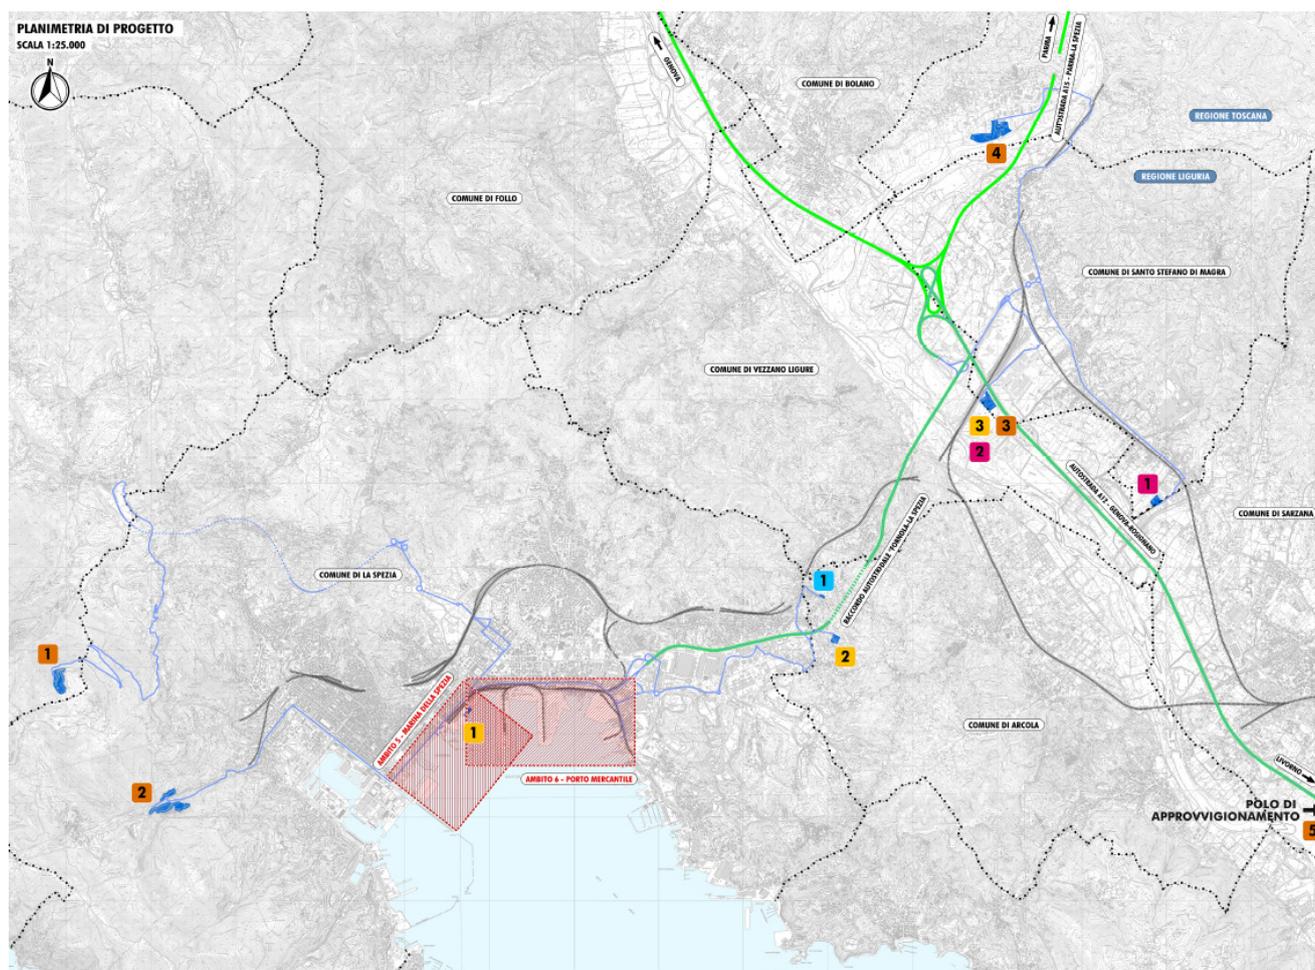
planimetria generale con individuazione dei percorsi di approvvigionamento/conferimento dei materiali (estratto dall'elaborato PP/SPA.02.02 – "Planimetria generale con indicazione dell'area d'intervento, dei poli di conferimento ed approvvigionamento dei materiali e dei percorsi dei mezzi operativi")
